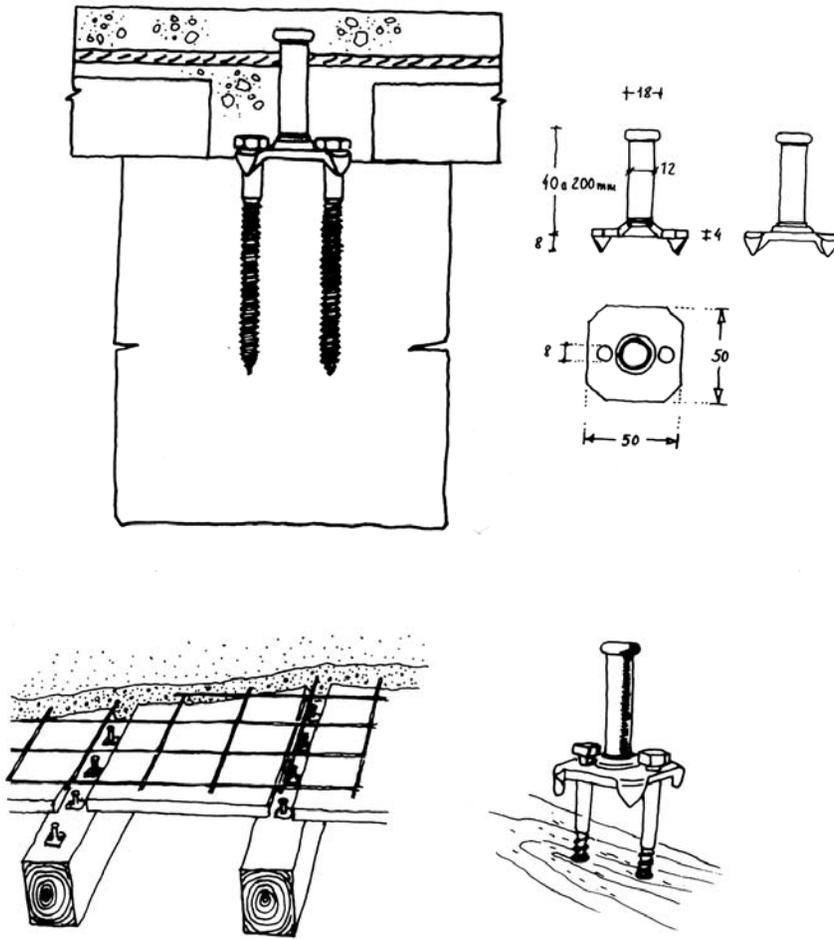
Sistema Tecnar para la conexión entre madera y hormigón.
